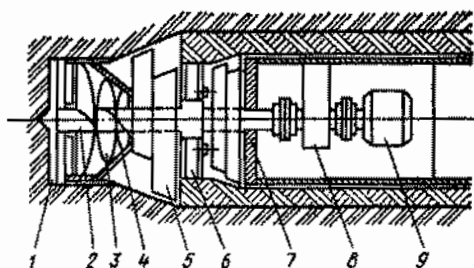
Горизонтальное бурение выработки под трубопровод грунтораскатывающей установкой:
